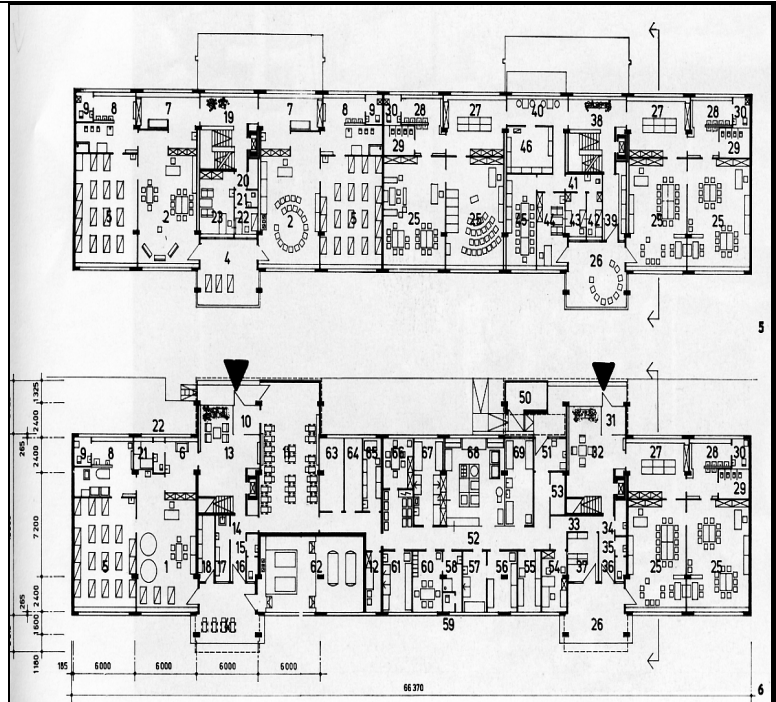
Grundrisse Erd- und 1. Obergeschoß
